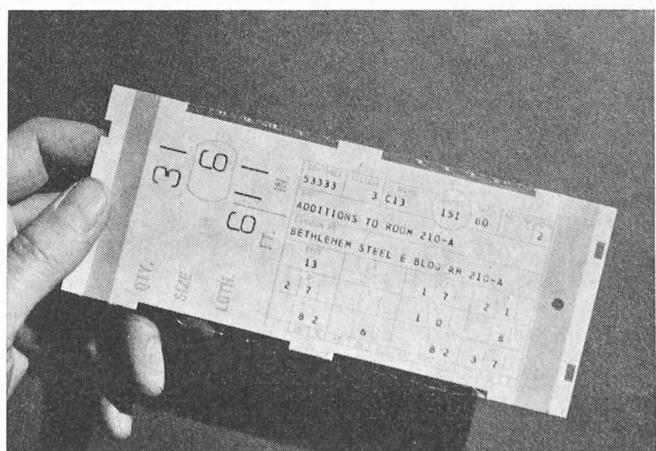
Etiquette pour identifier les paquets d'acières.
